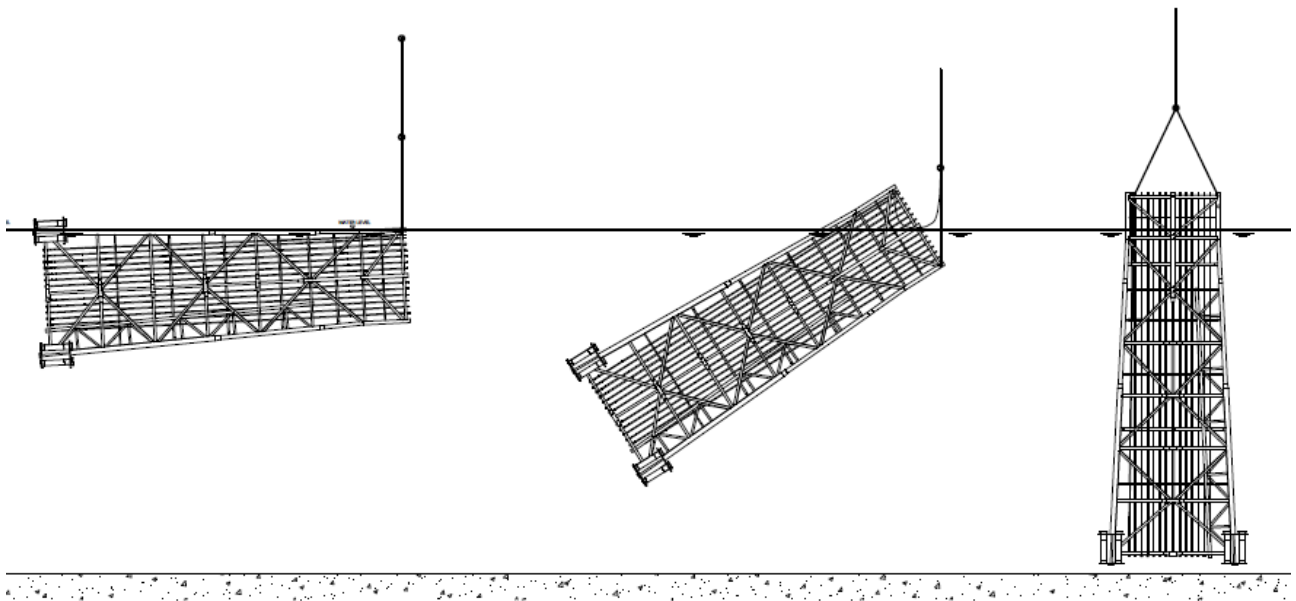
Jacket – sequenza di verticalizzazione e posizionamento sul fondo
